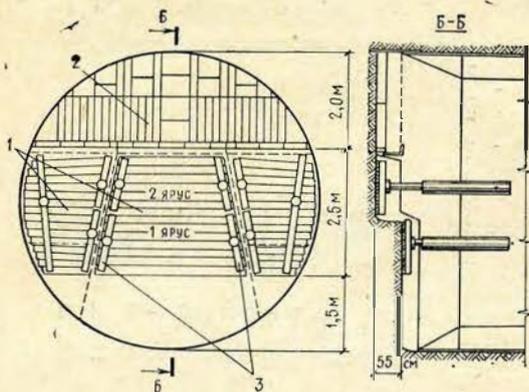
Крепление лба забоя вертикальными рас­секающими пластинами при проходке щитом в не­устойчивых грунтах:
